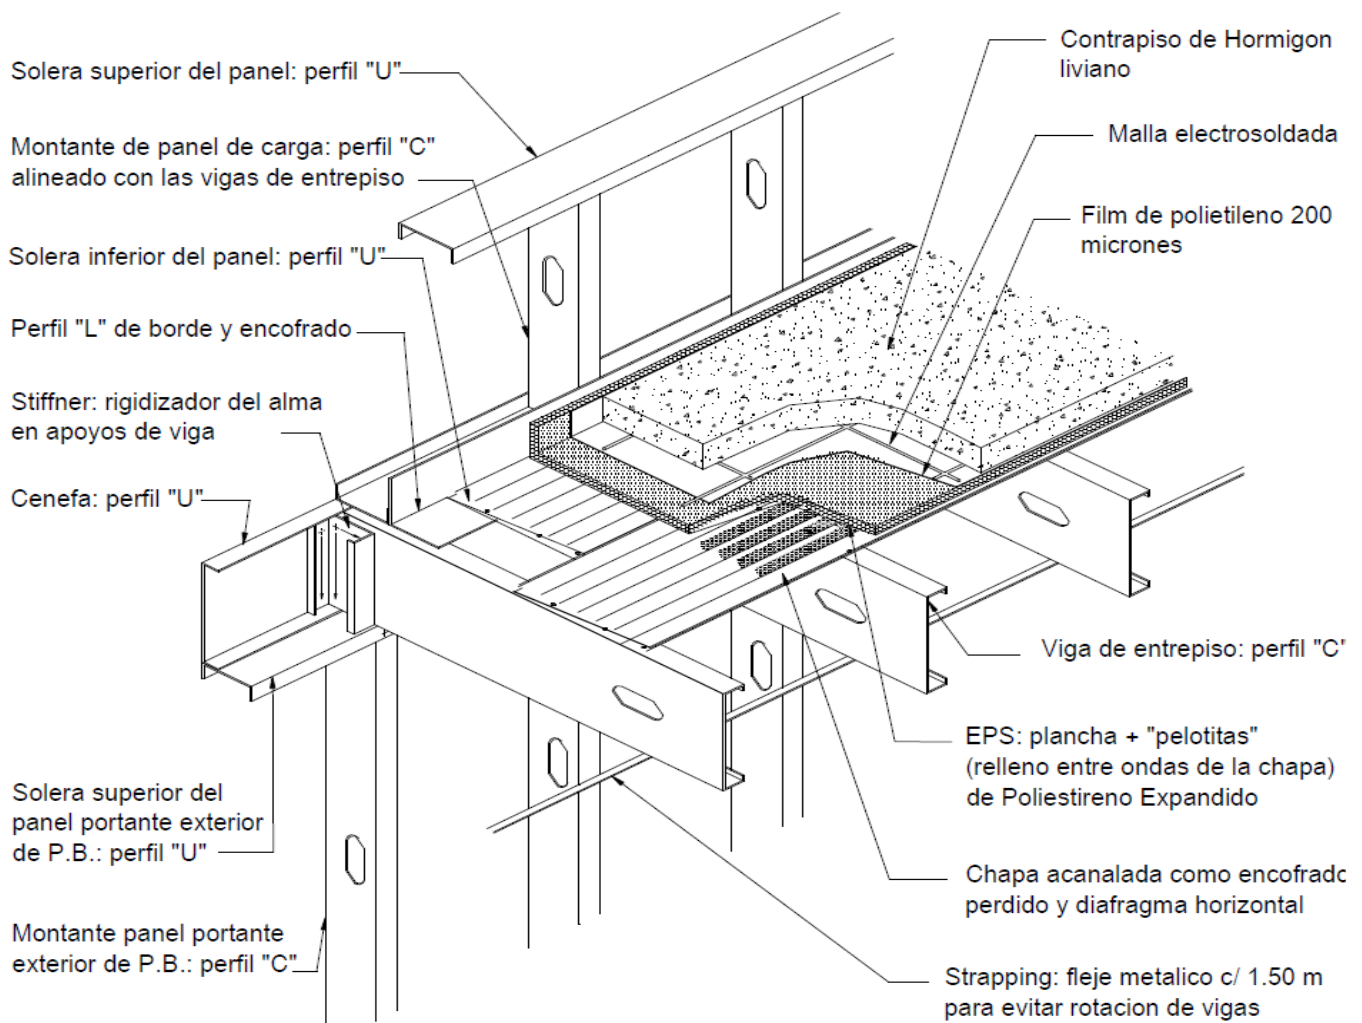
Estructura de una cubierta plana resuelta con Steel Framing.
